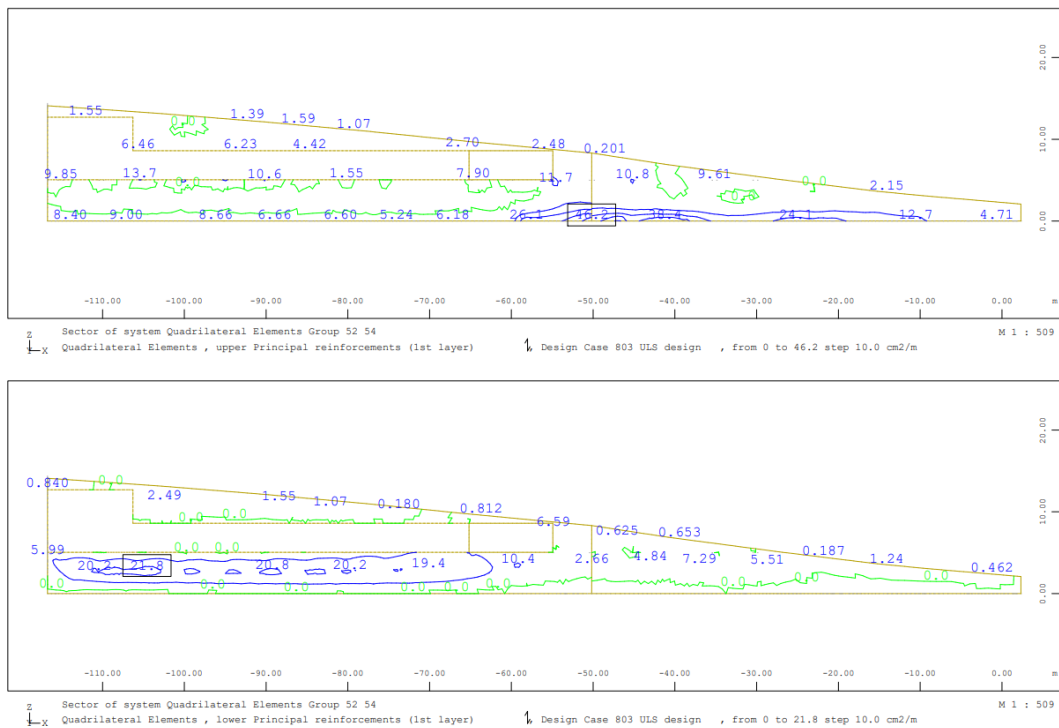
Armadura vertical na face exterior (sup.) e interior (inf.) – fachada Norte da Estação - ELU
